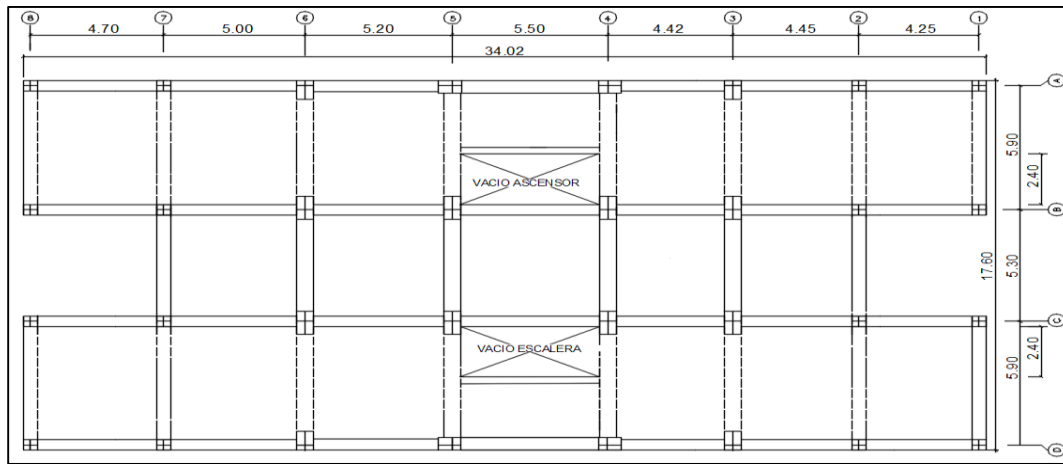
Esquema de vigas y orientación de las columnas de planta tipo
